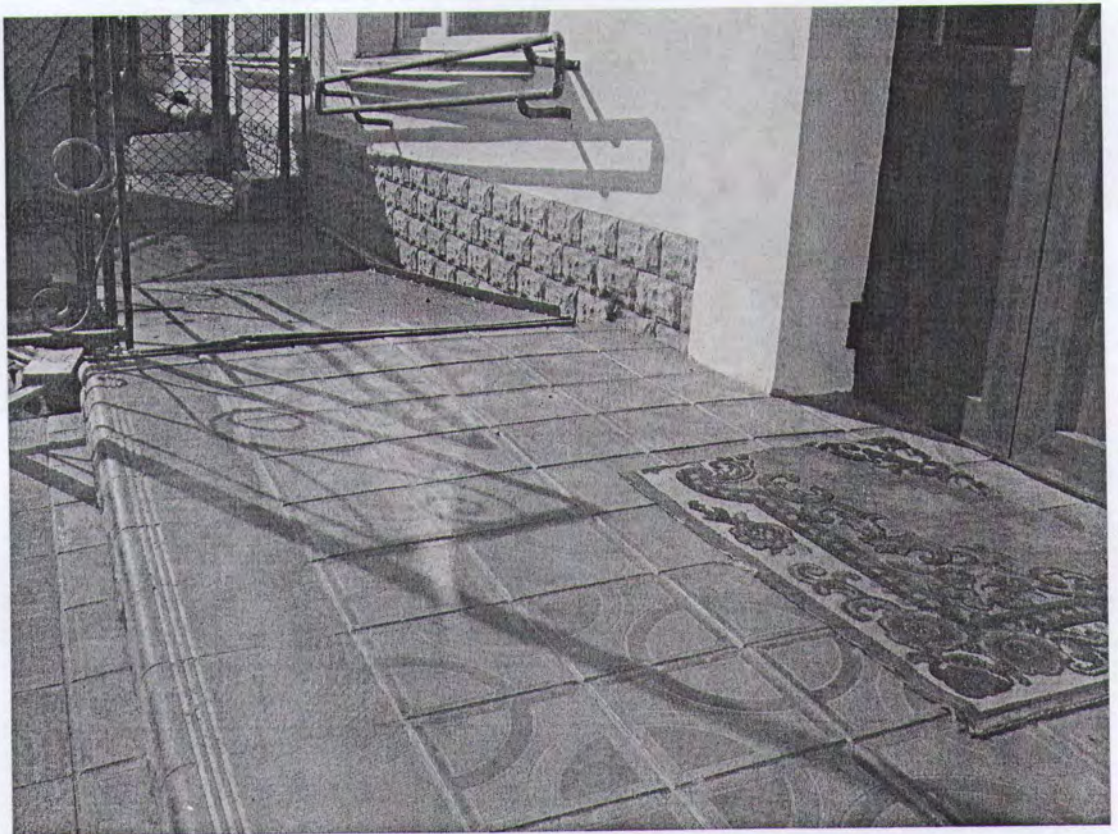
Вигляд пандусу зі сторони горизонтальної площадки перед входом до будівлі
